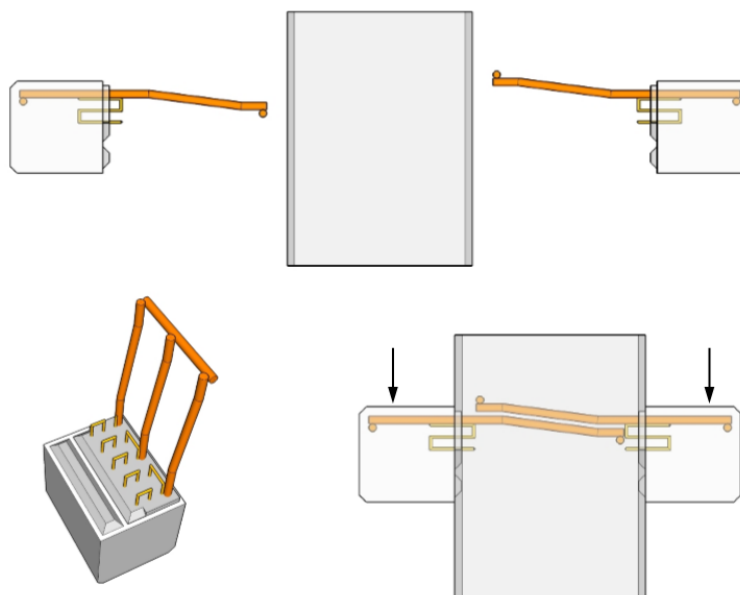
Epatas da concretagem do pilar, (COSTA 2009)
